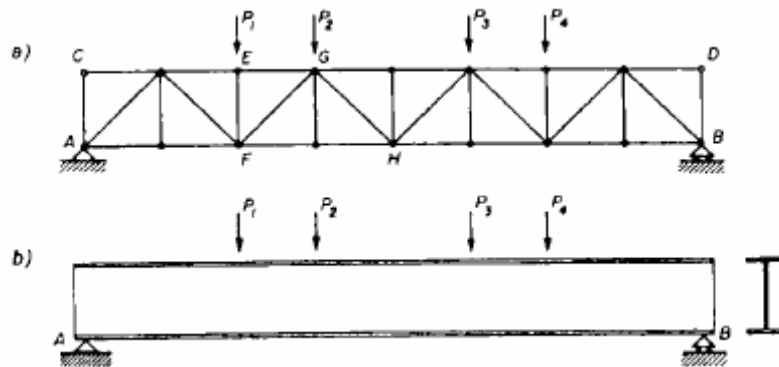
a) Viga en celosía. b) Viga de Alma Llena
